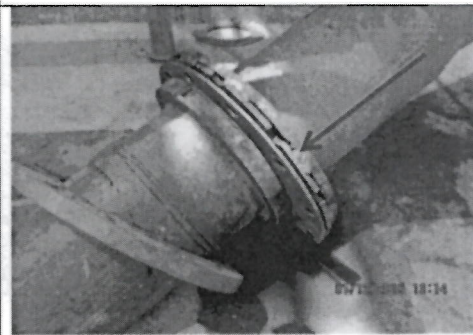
Vista de la tubería de vertimiento bloqueada con una plancha metálica.
